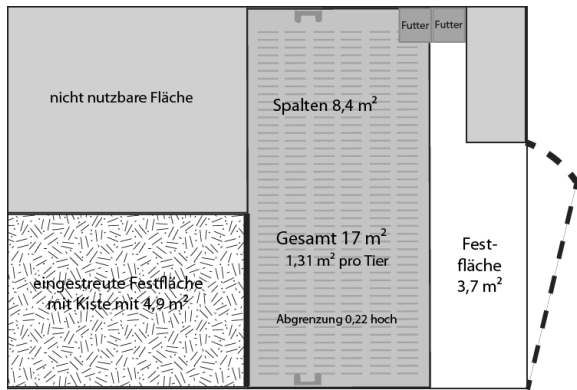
Grundriss und Flächenanteile der Versuchsbucht für 13 Tiere.
